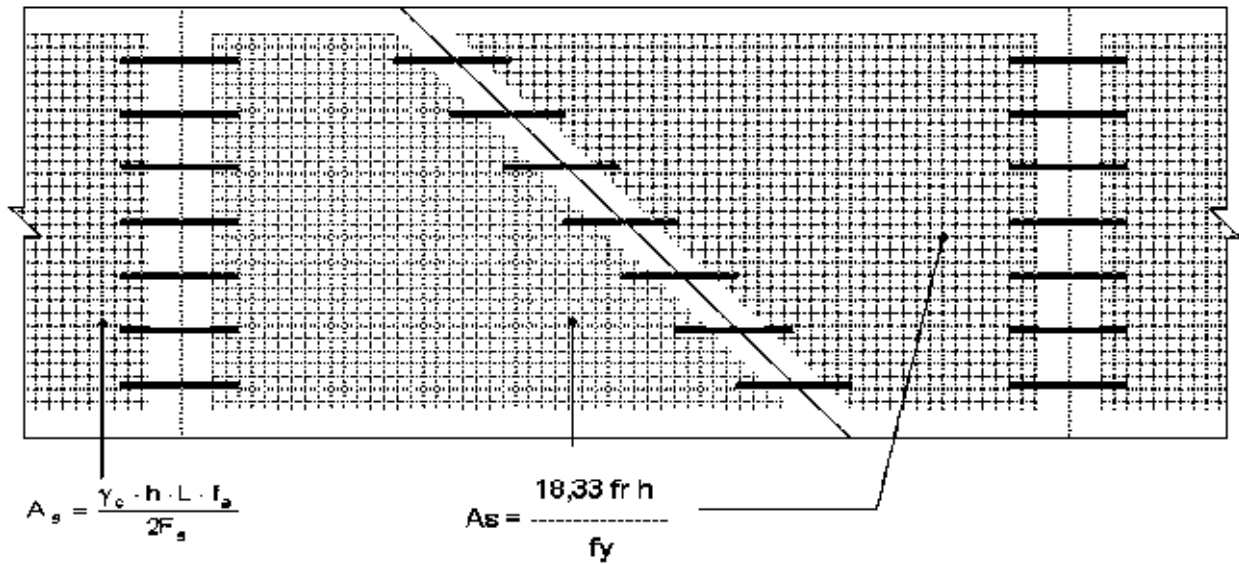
Juntas a menos de 90°. Pavimentos con juntas y acero de refuerzo
